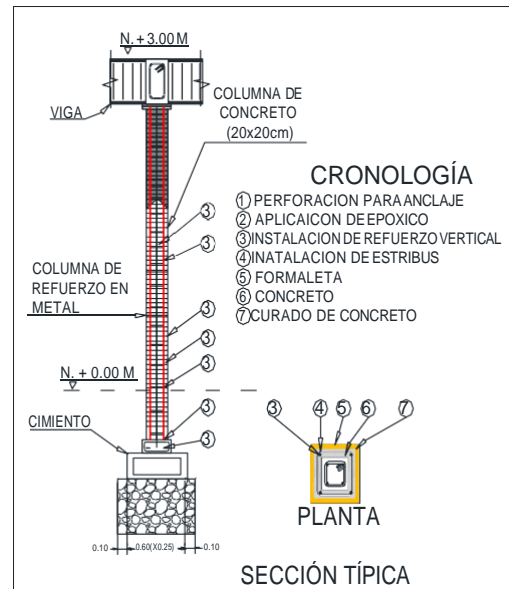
VISTA EN ALZADO DE LA COLUMNA CON REFUERZO POR ANILLO PERIMETRAL.
